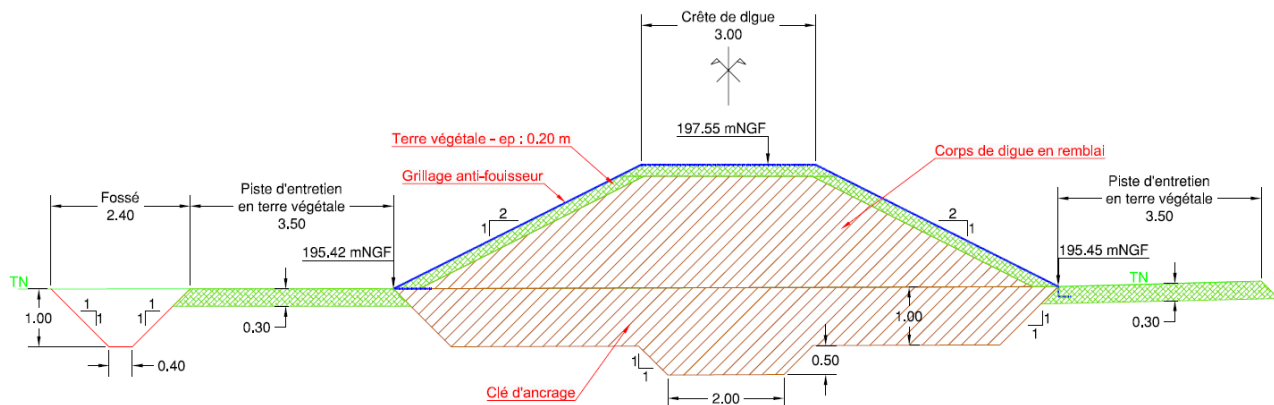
Coupe type de la digue (coupe A-A de la vue en plan du projet)
